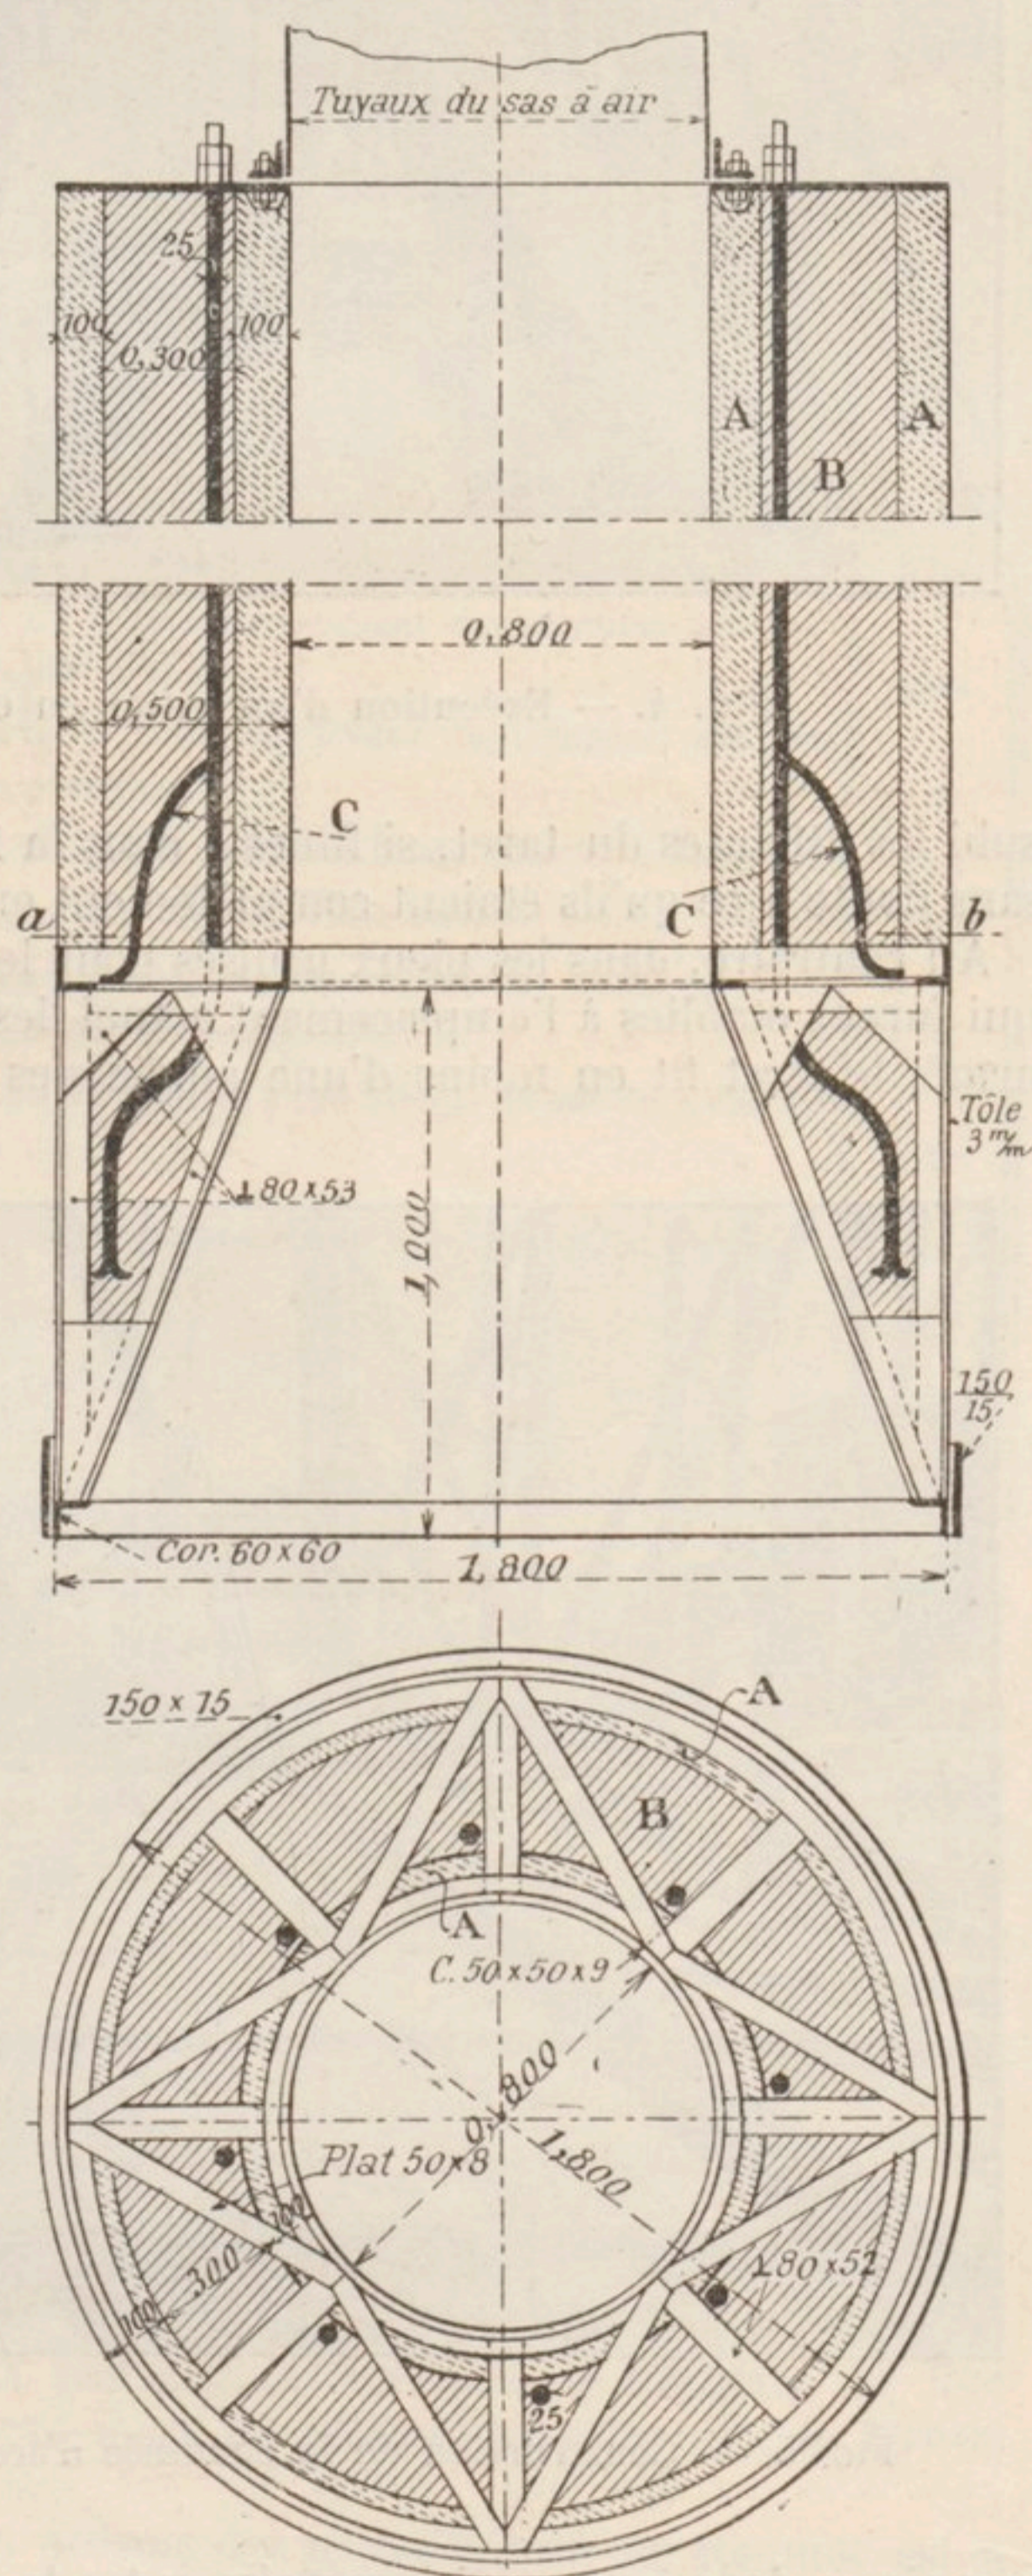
et 8. — Coupe et plan d'un pilier en ciment armé et béton.
